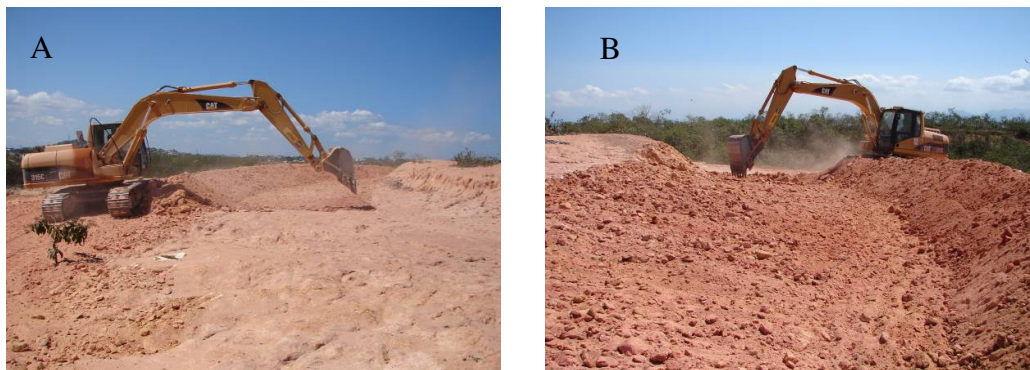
Processo de construção do Terraço a: A – vista para montante (leste); B – vista para jusante (oeste).
